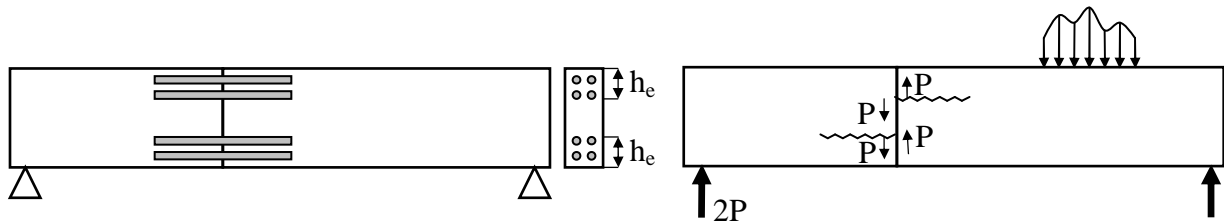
Fissuration du bois dans le cas d'un assemblage symétrique par goujons collés
